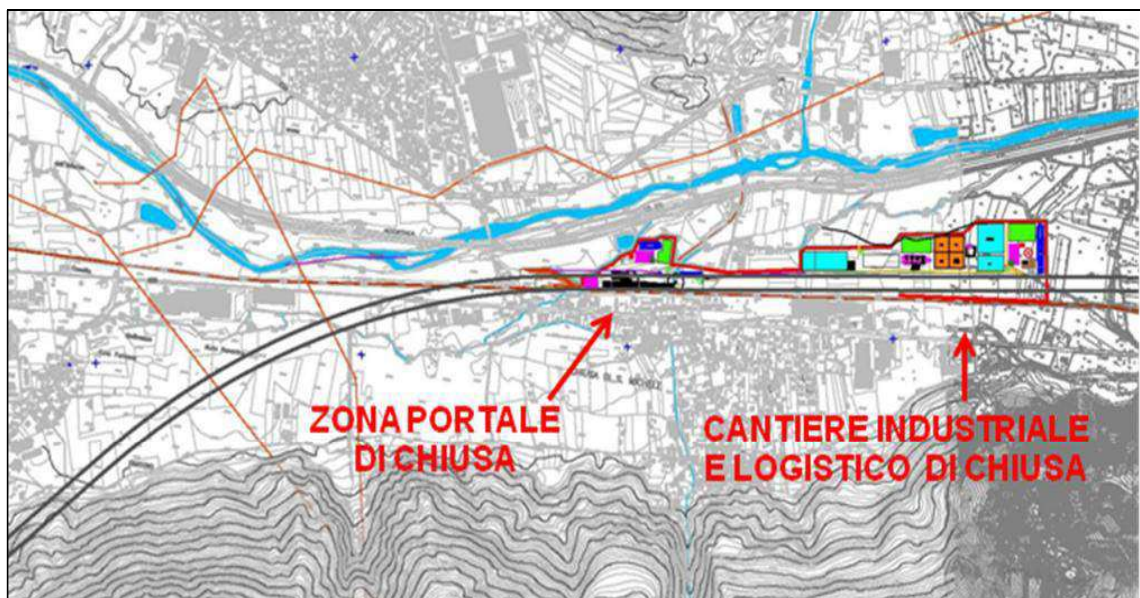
Cantieri nell'area di Piana delle Chiuse.
